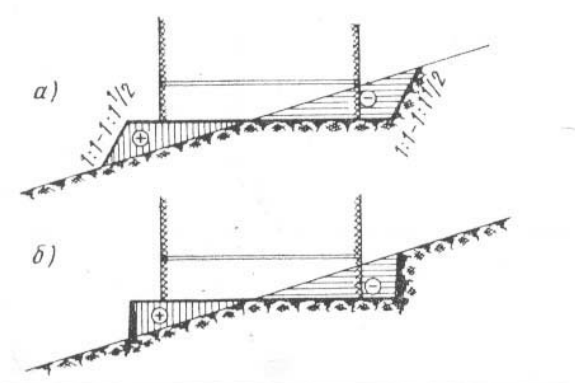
Вертикальная планировка площадки в полувыемке – полунасыпи: а – с откосами; б – с подпорными стенами.
